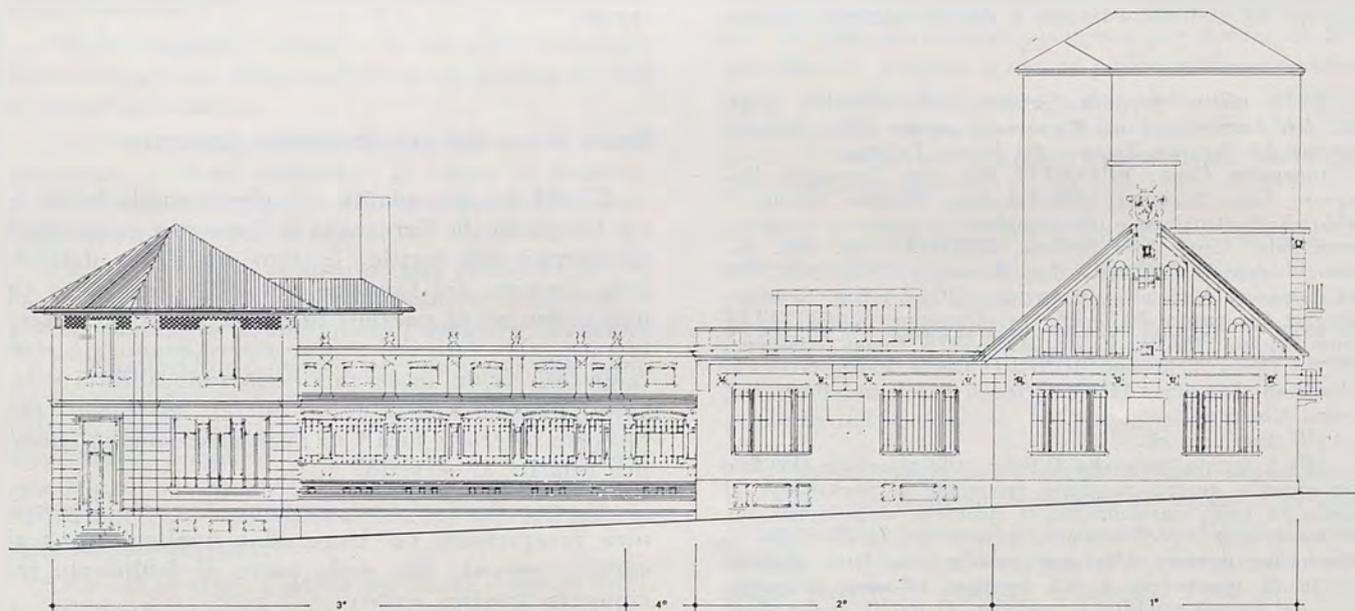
Bagni e lavatoi del Quartiere San Donato, prospetto su via Saccarelli, con l'indicazione dei successivi interventi di costruzione.
